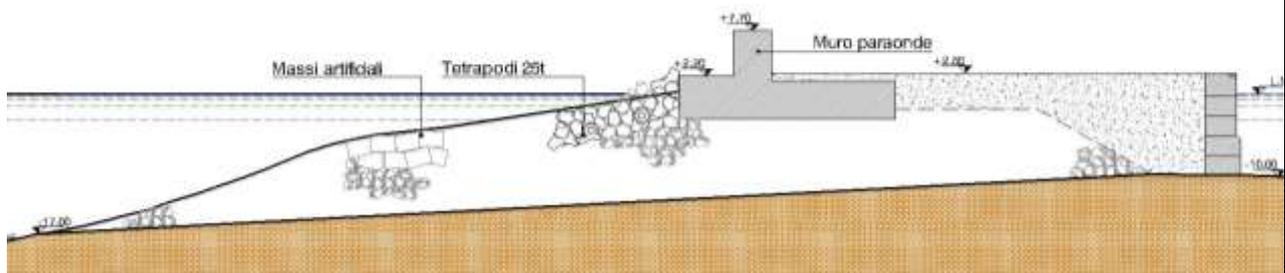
Sezione tipo dell'antemurale Traiano in corrispondenza della banchina traiana
